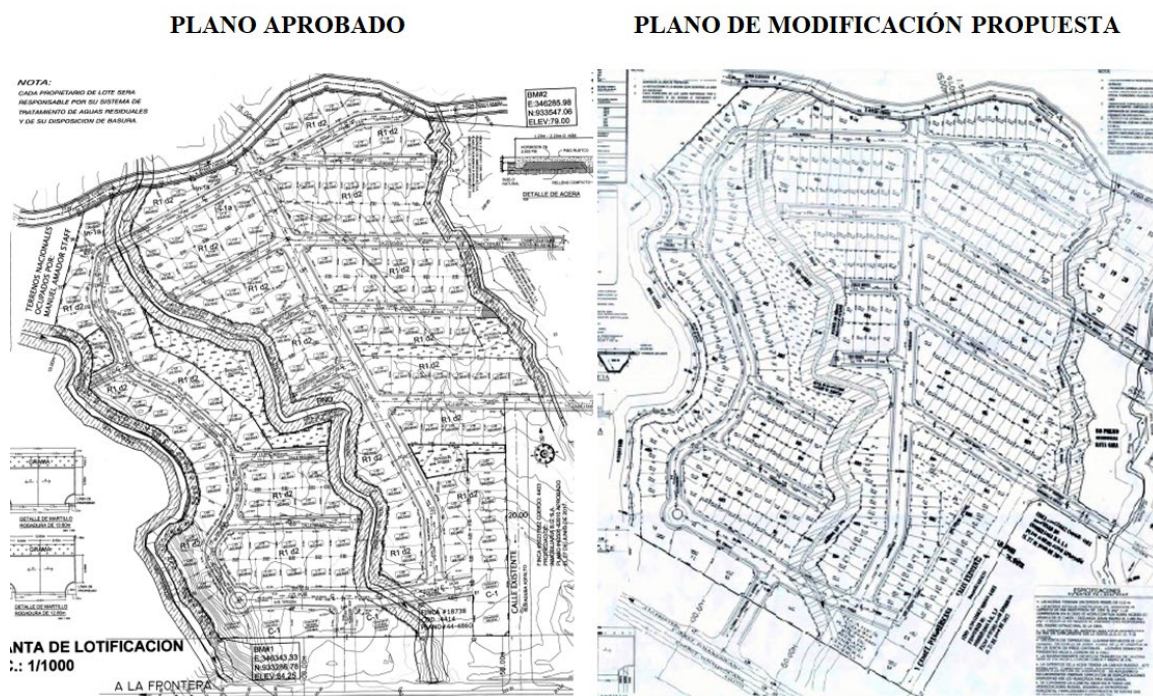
Imágenes de los Planos del proyecto Residencial Villas de Santa Clara, (izquierda): Plano aprobado en el EsIA, (derecha): Plano con la zonificación RBS. Fuente: Planos del proyecto.
